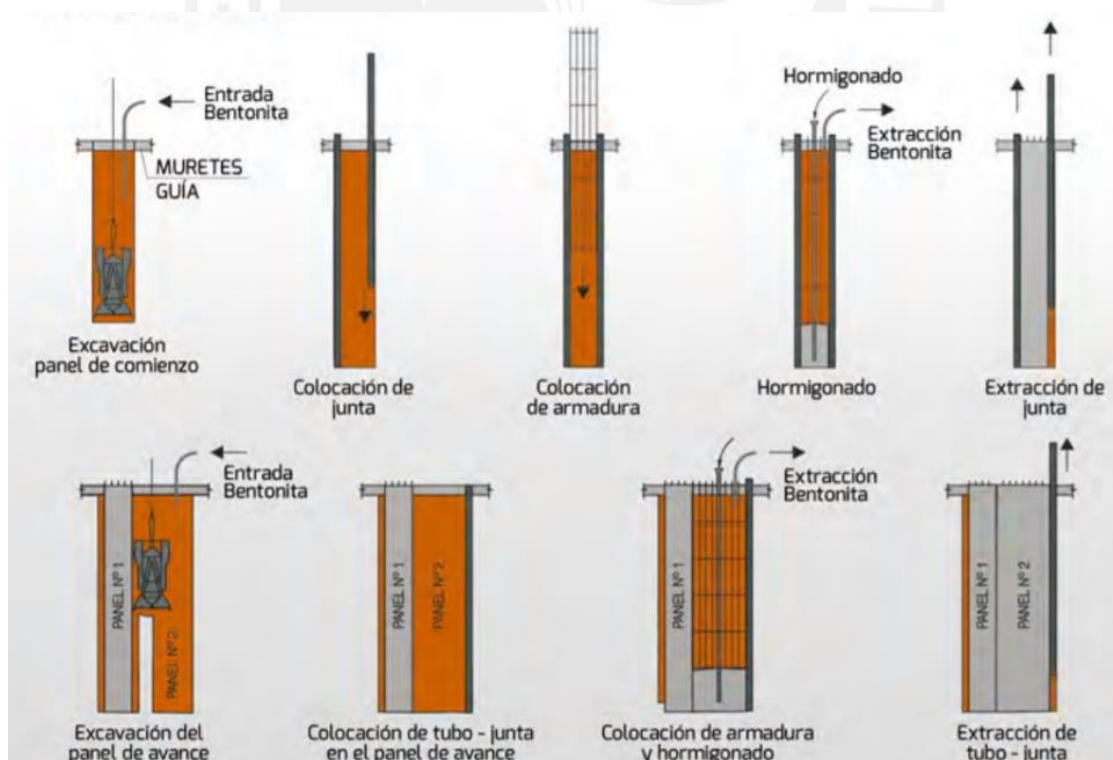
Ejecución de muros pantallas. Fuente: Pilotes Terratest (2018).
